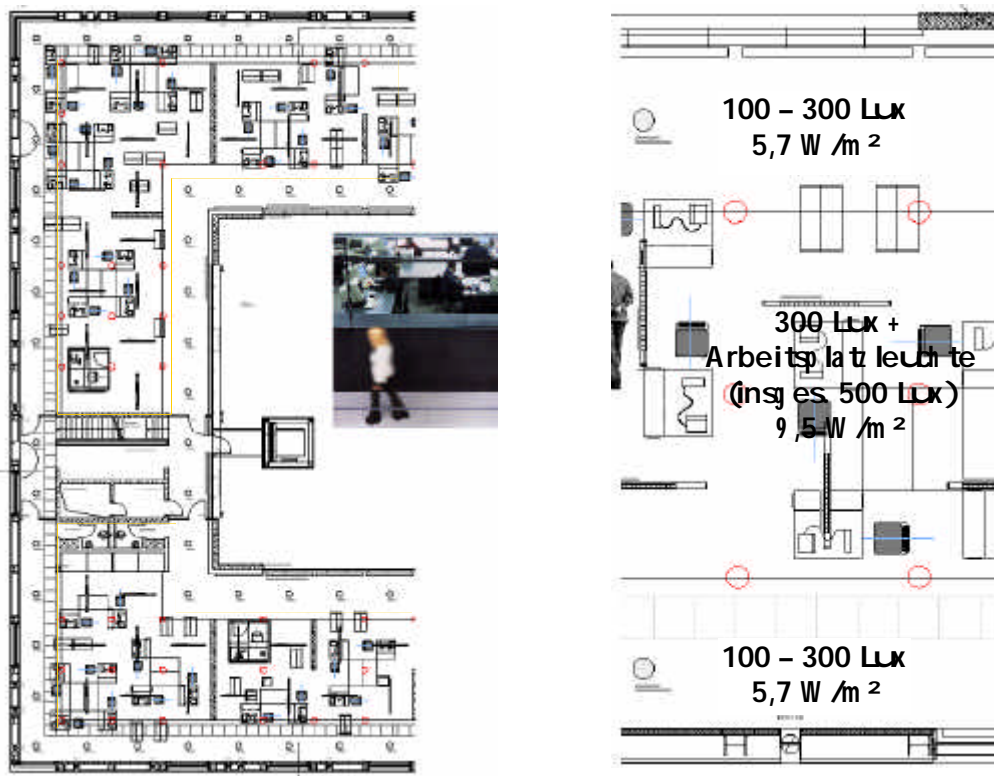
Beleuchtungszonen: links Teilgrundriss mit markierter Arbeitsplatzzone, rechts: Detail Grundriß mit Angabe Beleuchtungsstärken.
